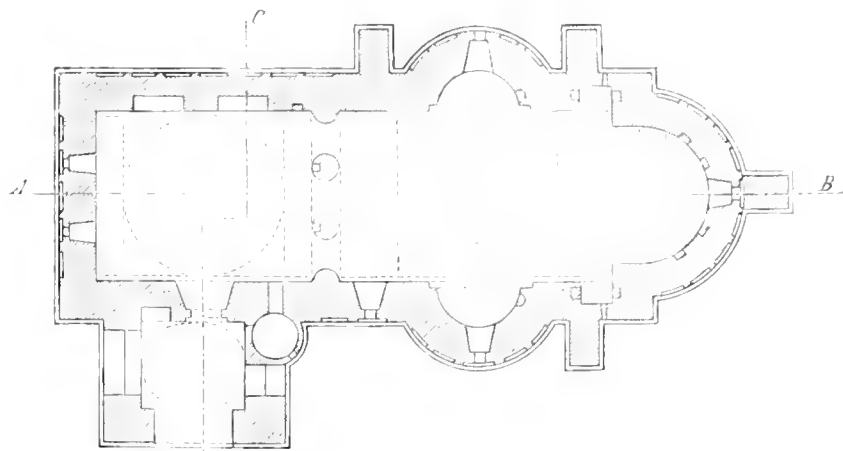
(Miroutz Kirche in Suczawa, Grundriſſ.)
